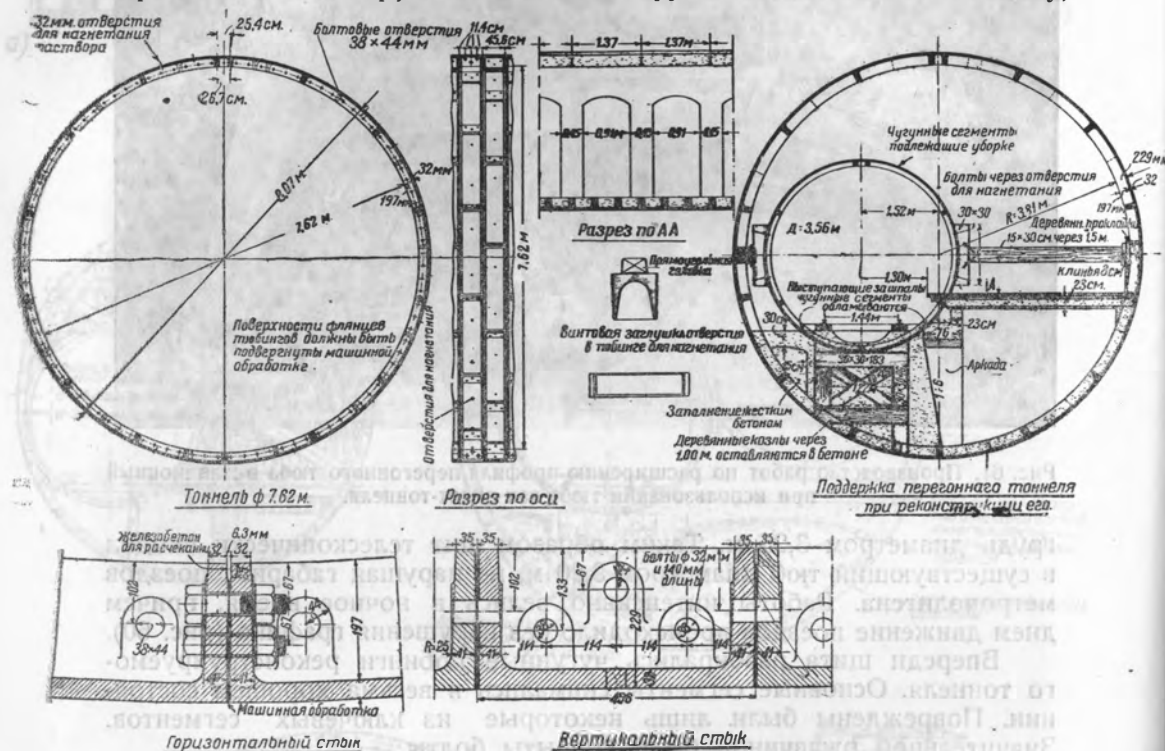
Реконструкция туба перегонного профиля, в станционный, без перерыва движения.
